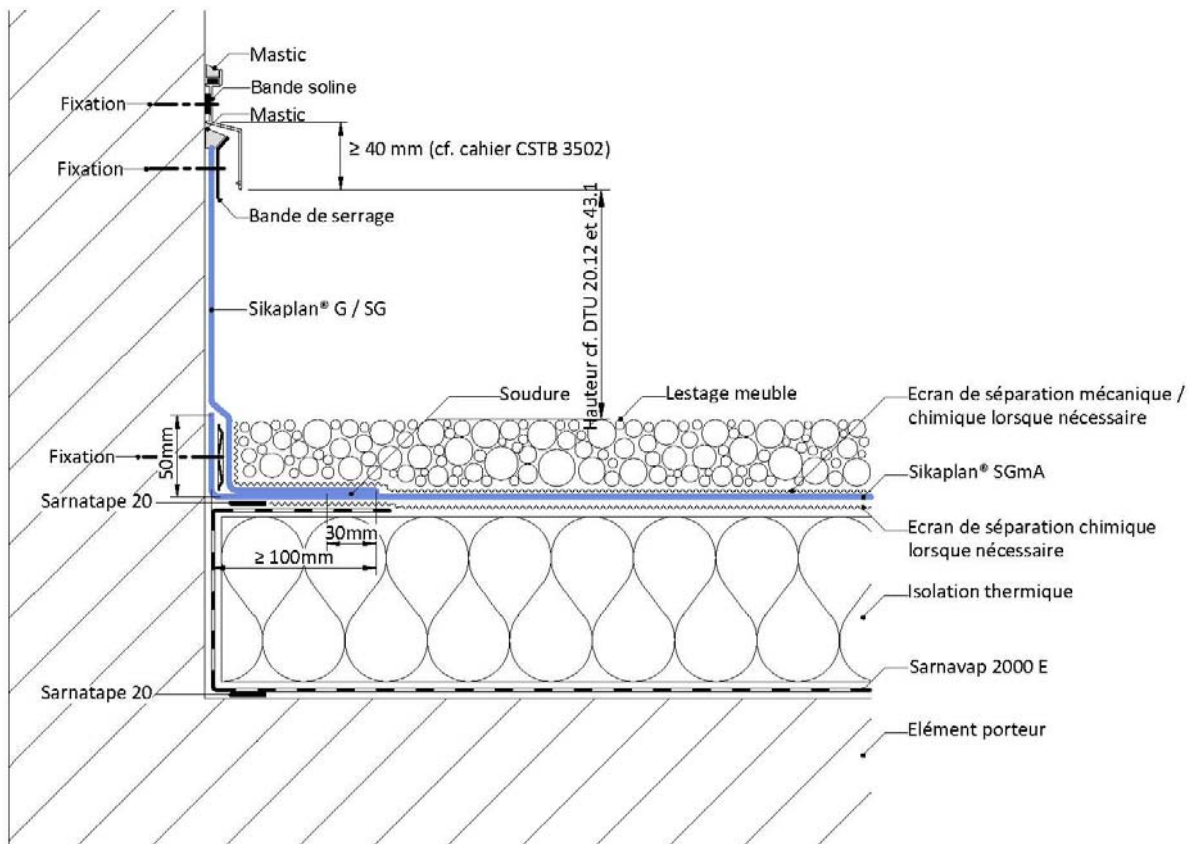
Relevé d'étanchéité avec bande de serrage sous bande soline – Travaux neufs sur maçonnerie (variante)
